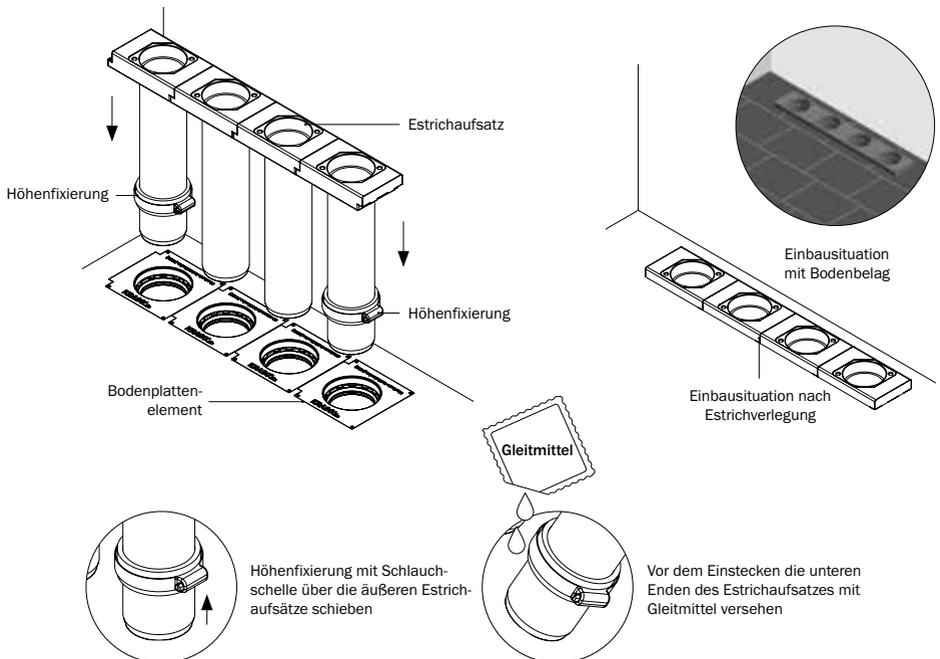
Einstecken des Estrichaufsatzes mit Höhenfixierung, Einbausituation
